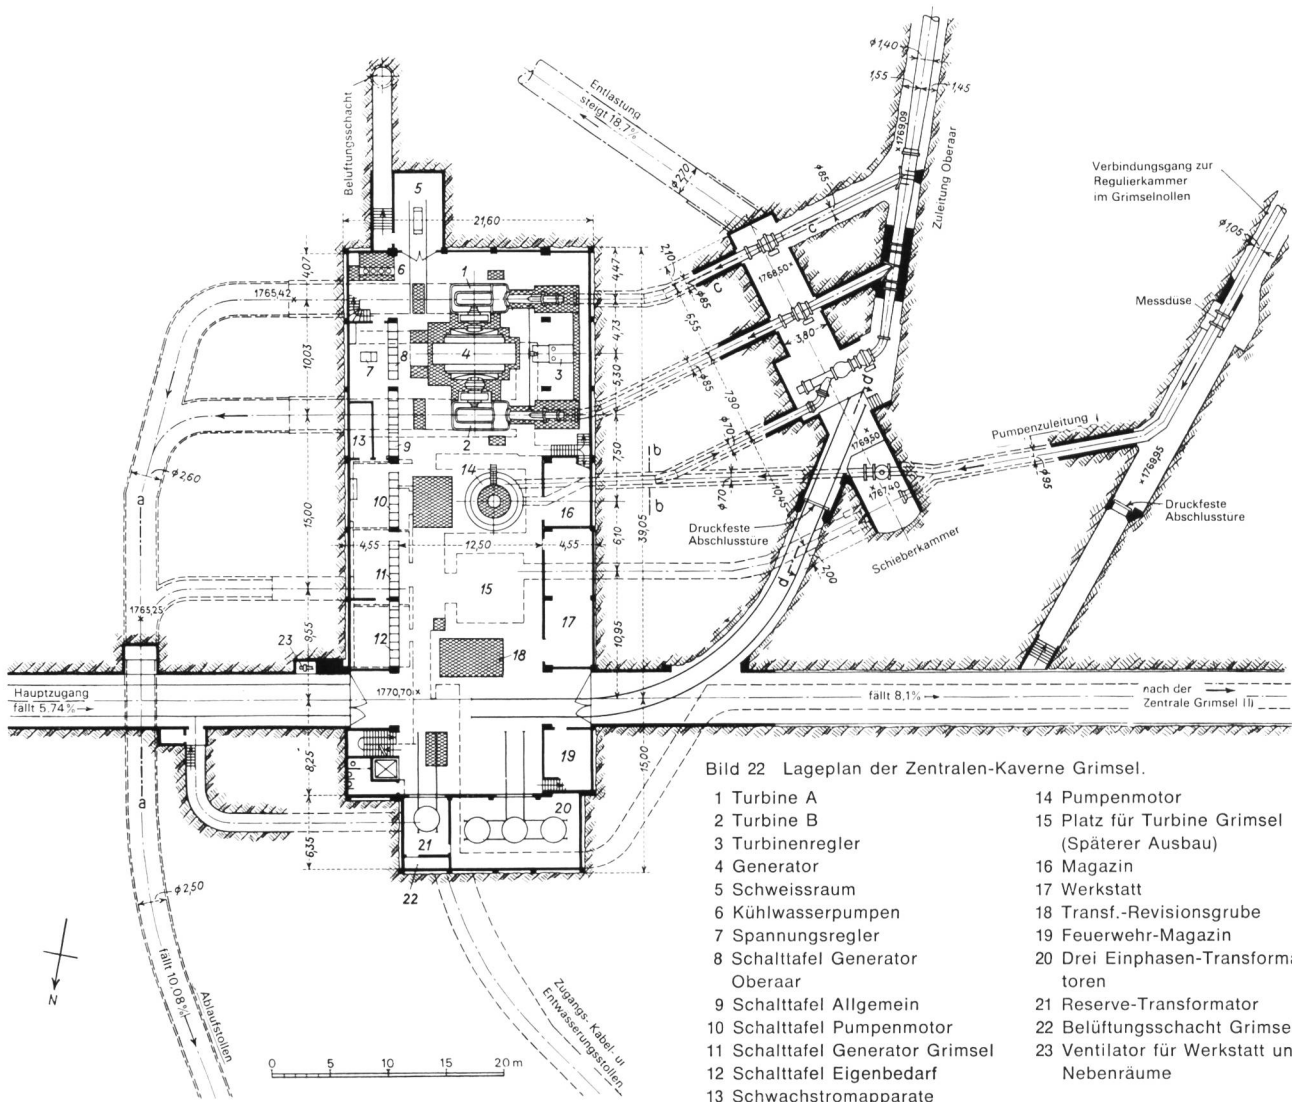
Lageplan der Zentralen-Kaverne Grimsel.
